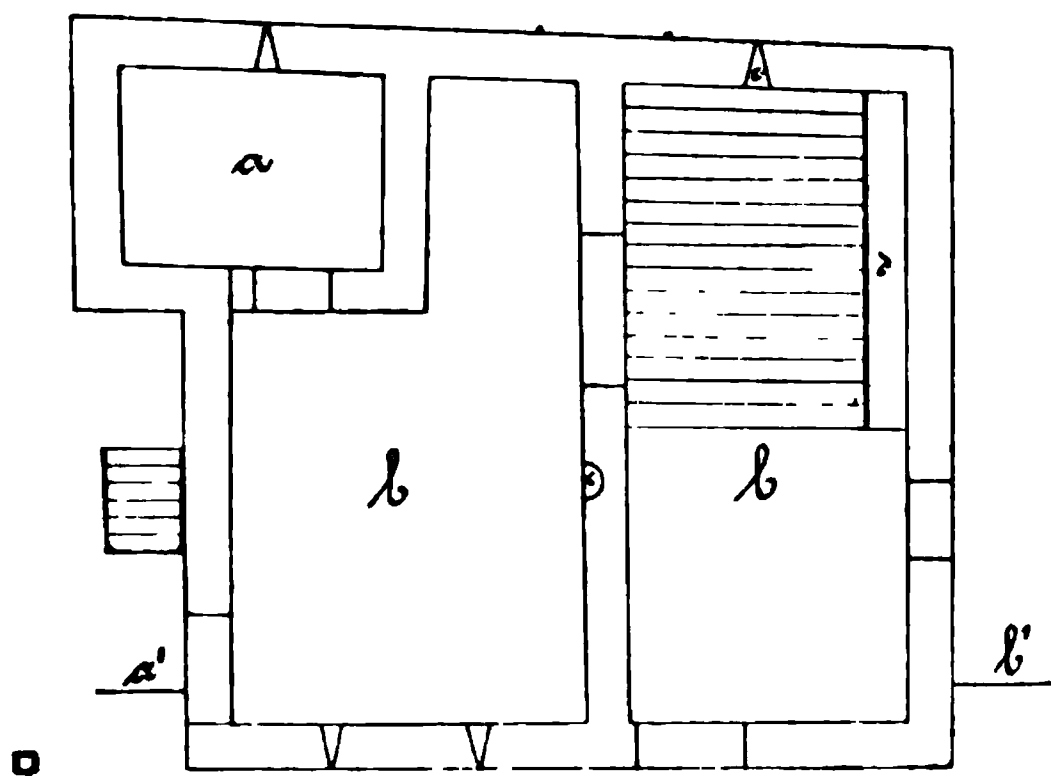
a. Grundriss des Erdgeschosses.
